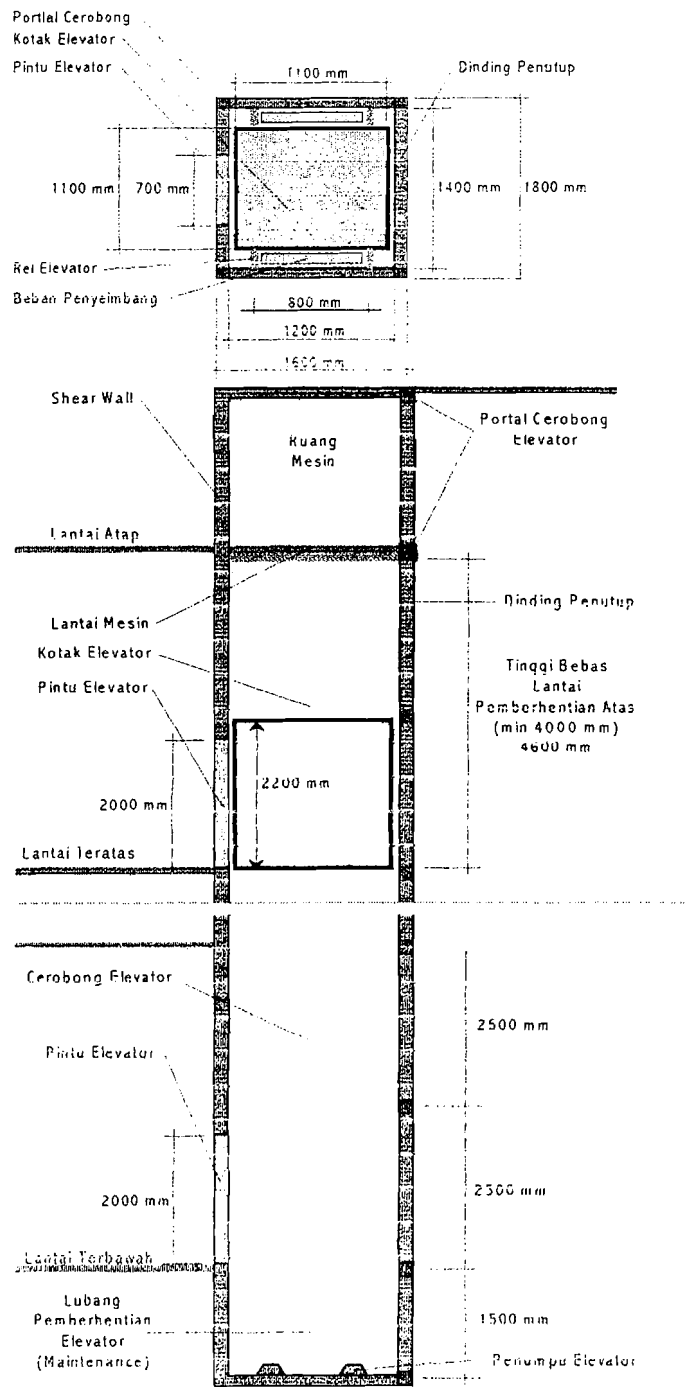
Denah lift dan tangga dalam dinding geser
